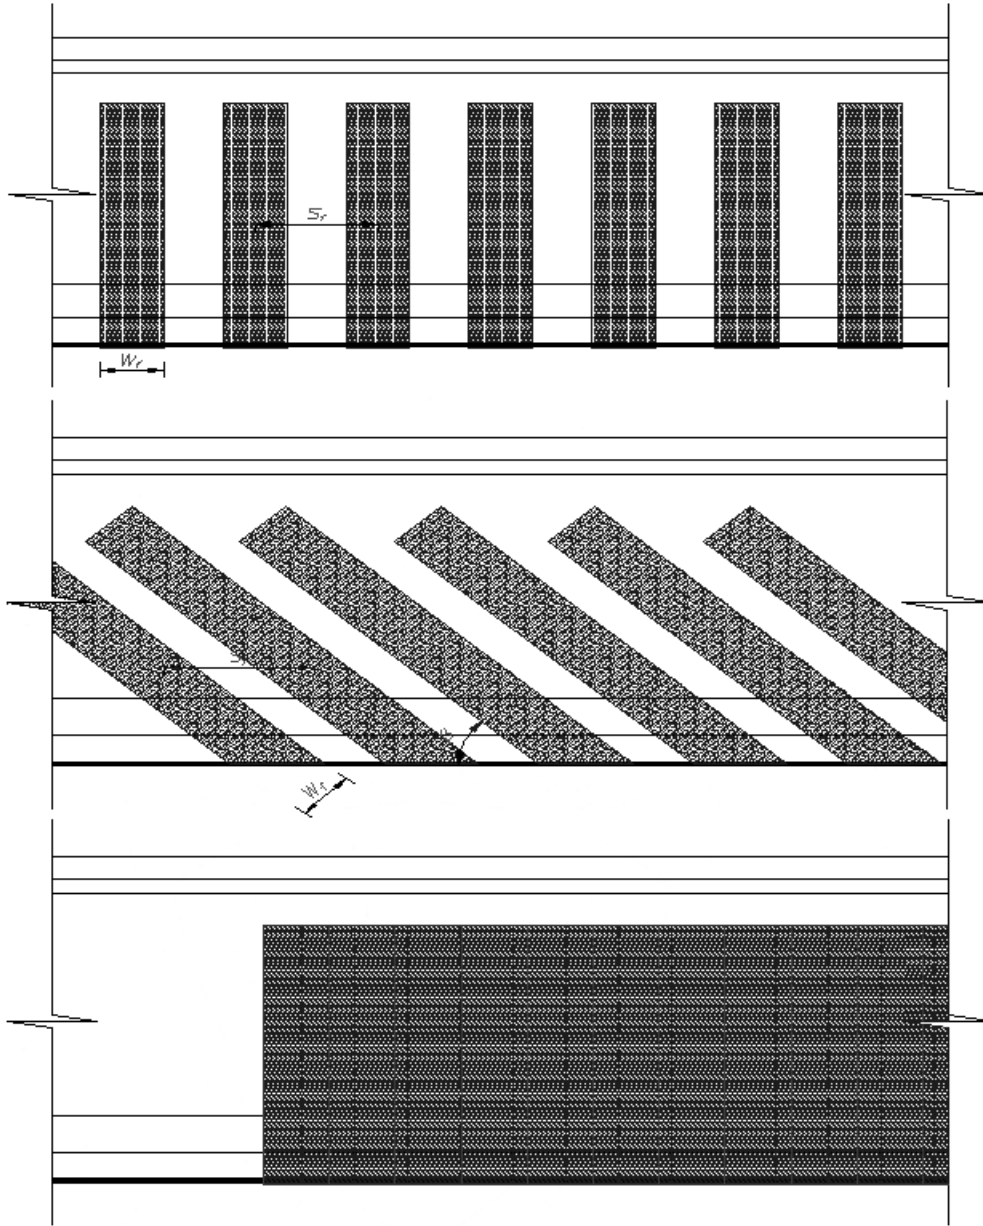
FRP colocado por bloques y de manera continua. (American Concrete Institute, 2008)
